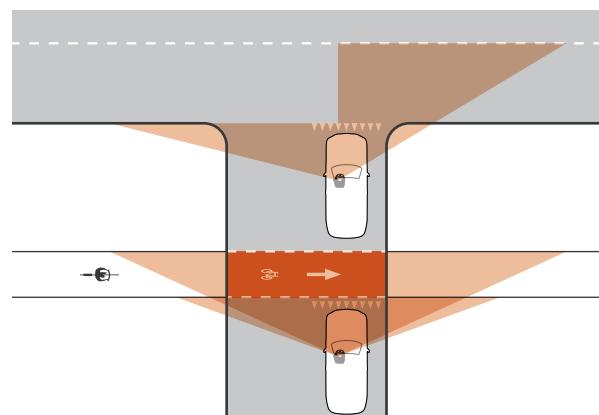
Toepassing oprijzicht op voorrangsweg met vrijliggend fietspad met opstelruimte tussen fietspad en voorrangsweg
